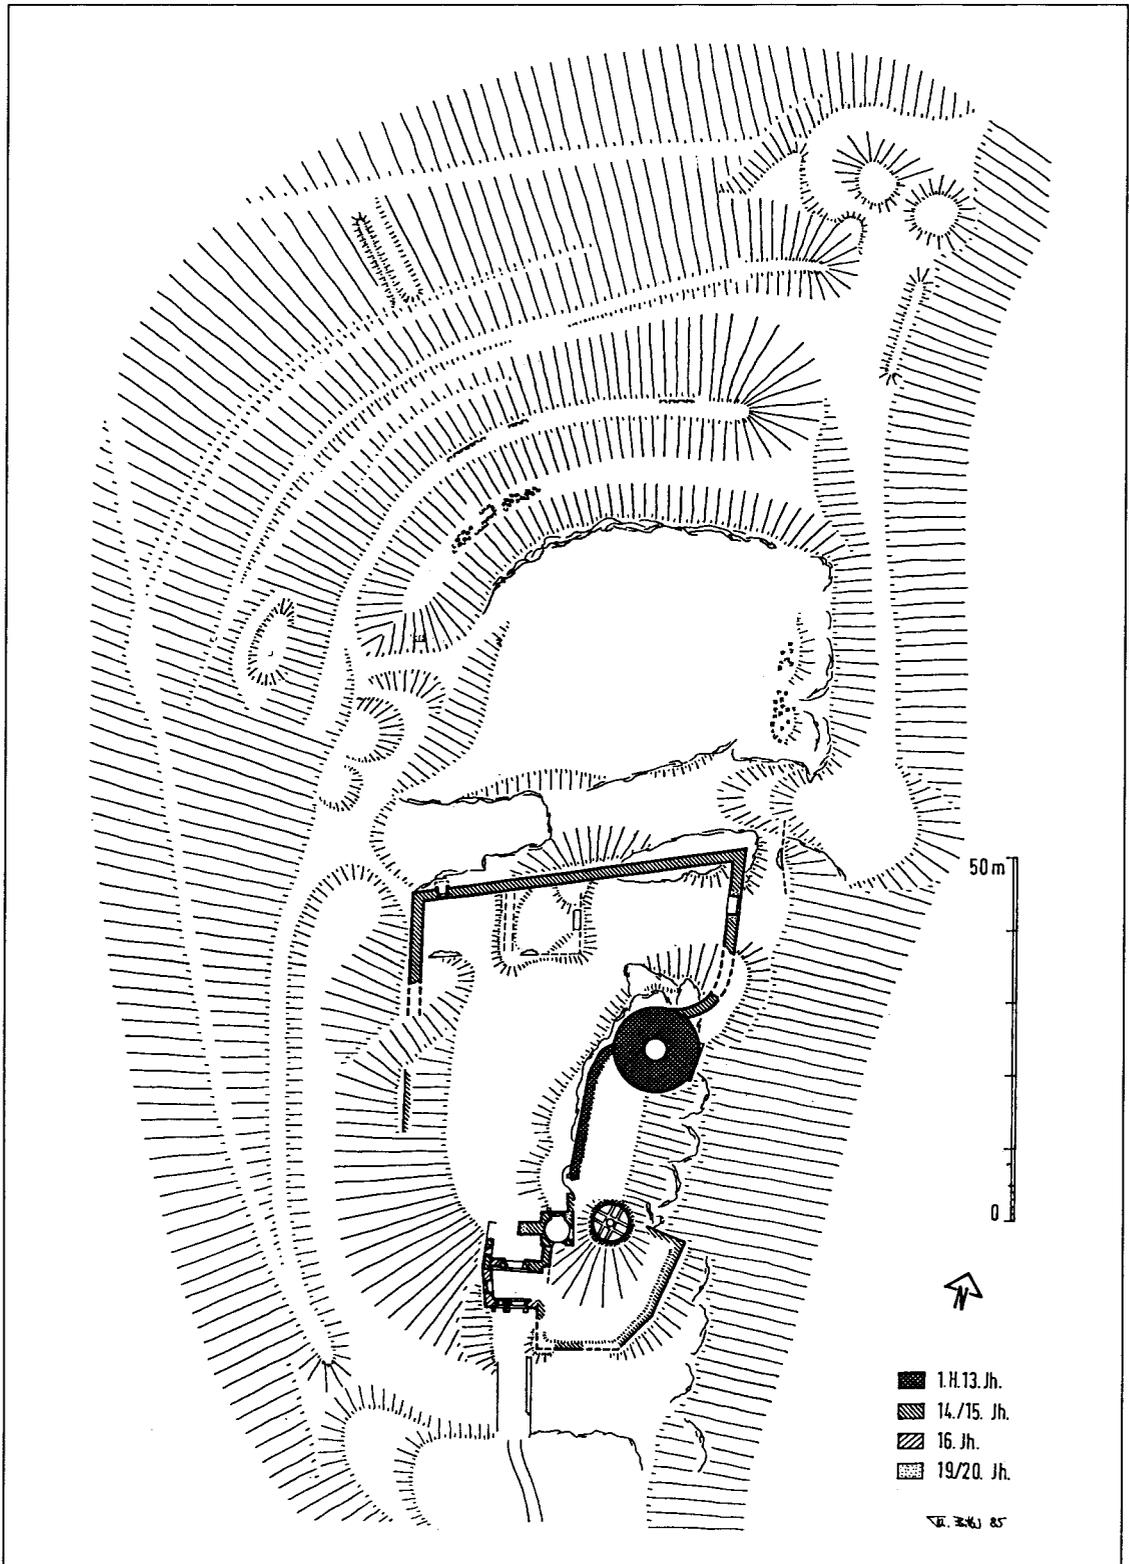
Hohrappoltstein. Baualterplan (Th. Biller unter Verwendung des Grundrisses von B. Ehardt; Wälle und Gräben unmaßstäblich).
